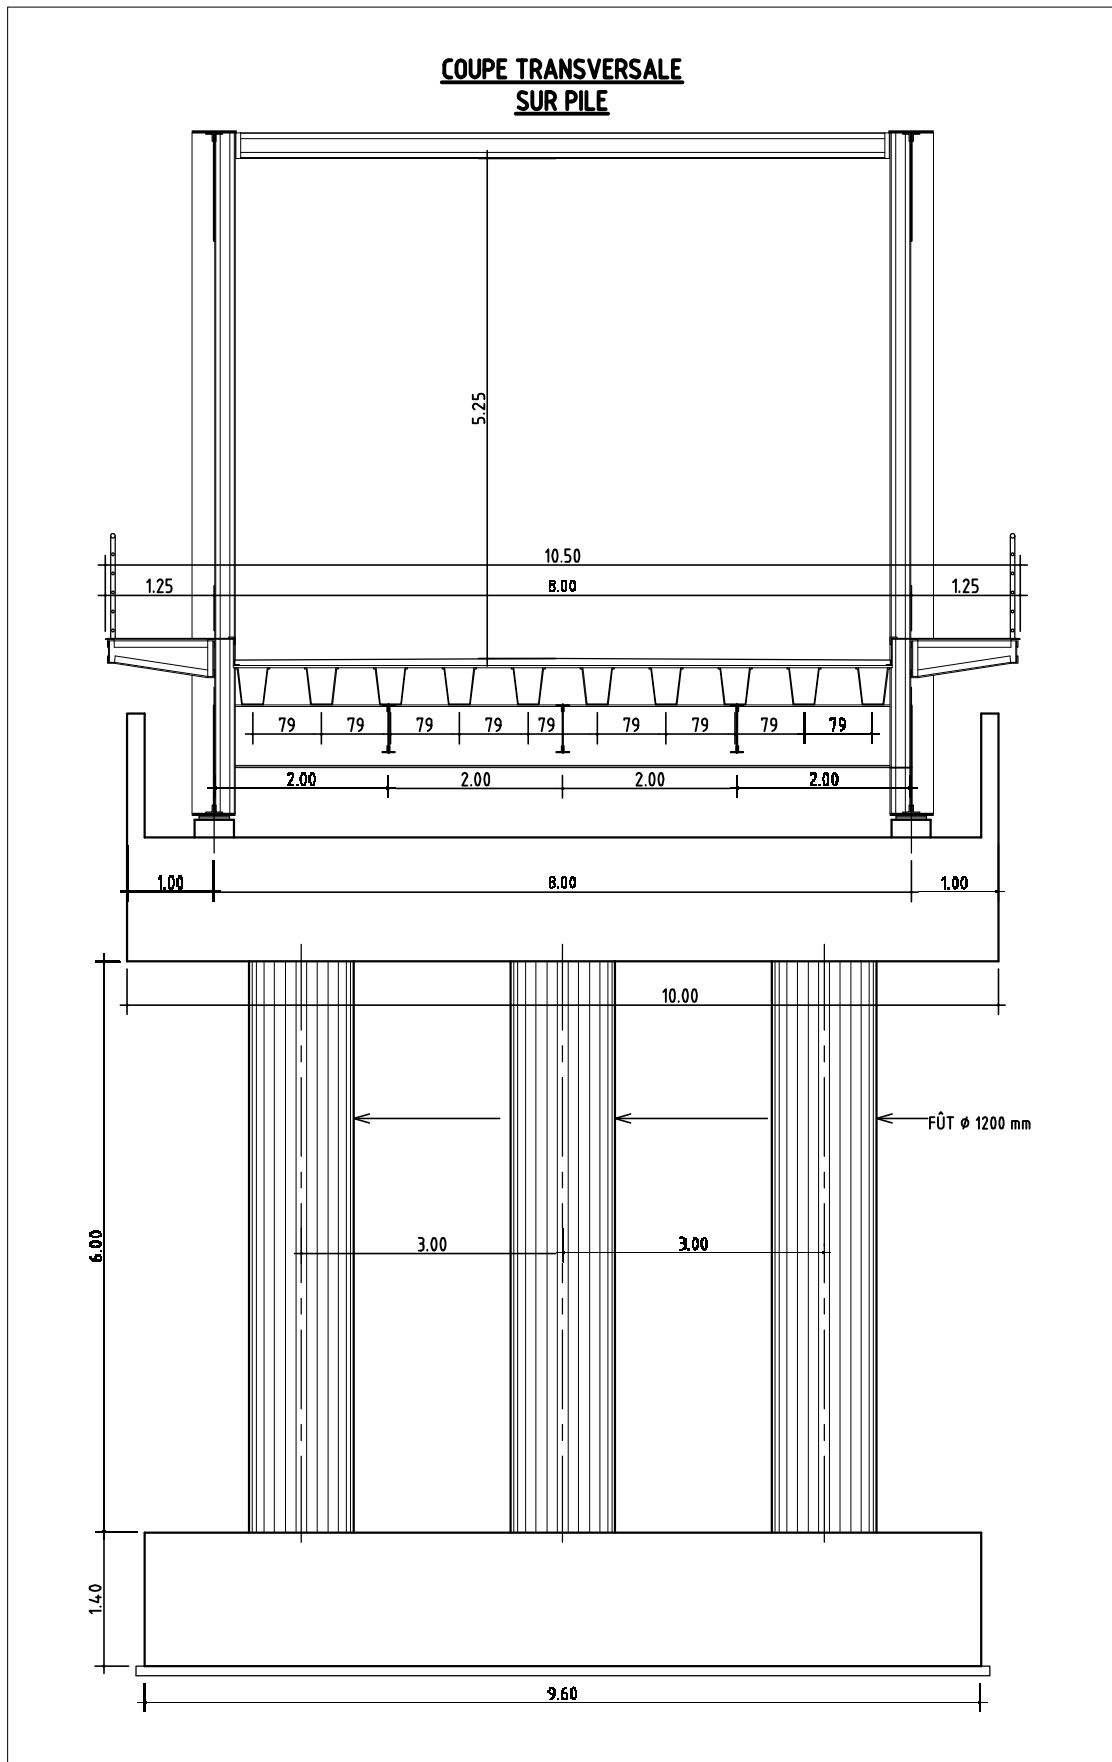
coupe transversale sur pile – pont a tablier métallique.
